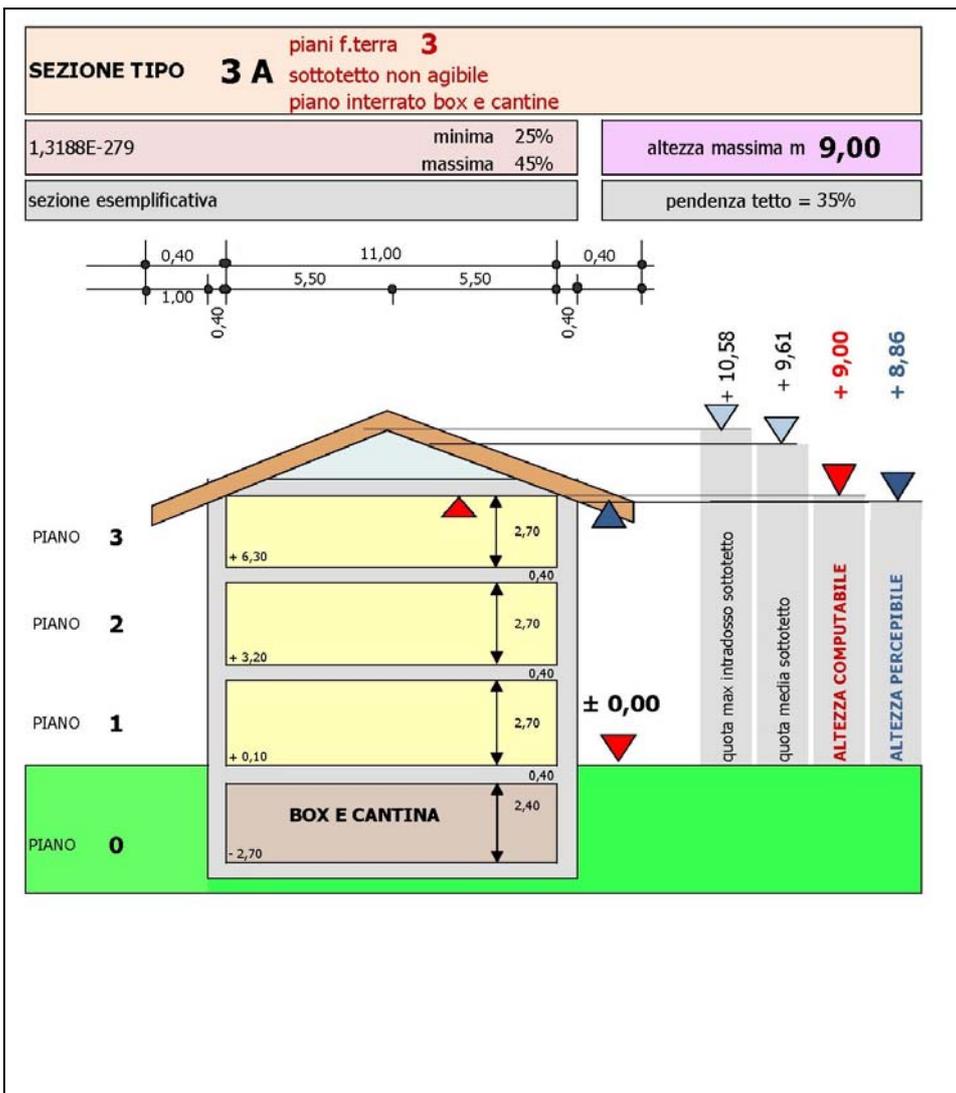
"Sezione tipo" residenziale a 3 piani fuori terra
